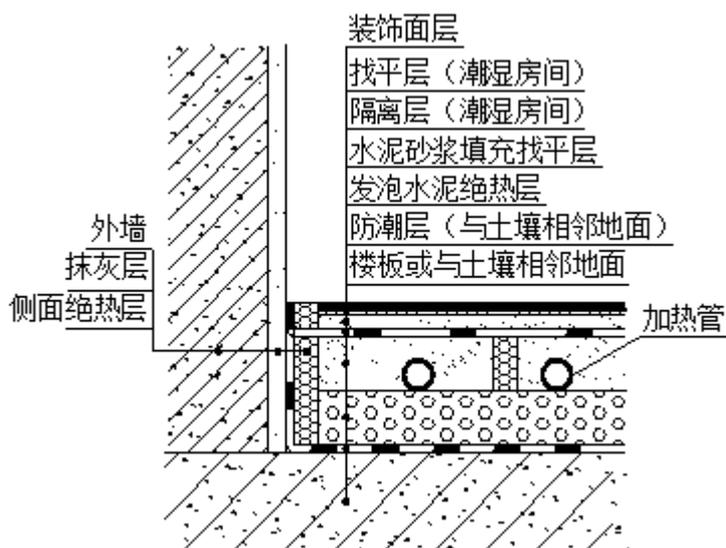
采用发泡水泥绝热层的混凝土填充式热水供暖地面构造
